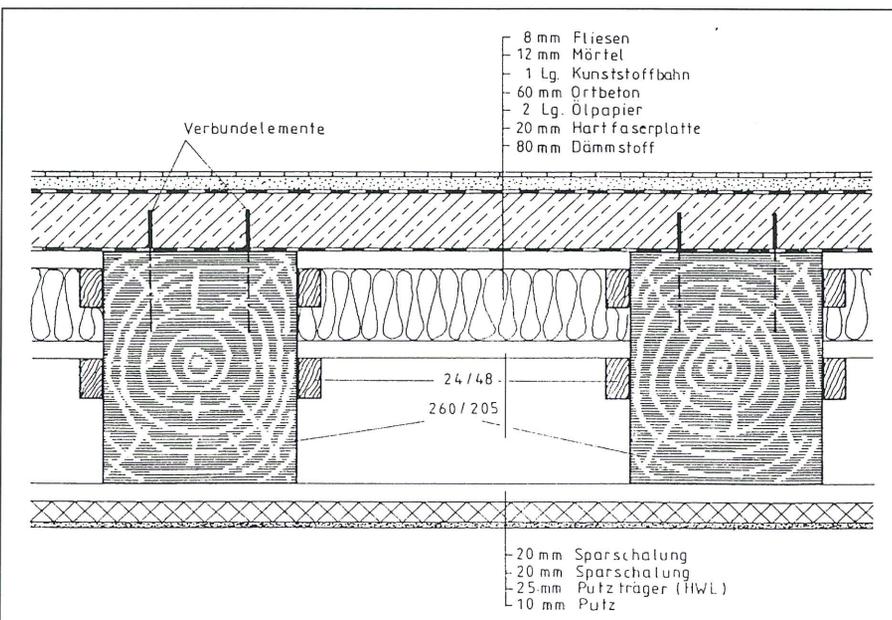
Holz-Beton-Verbunddeckenvariante.
